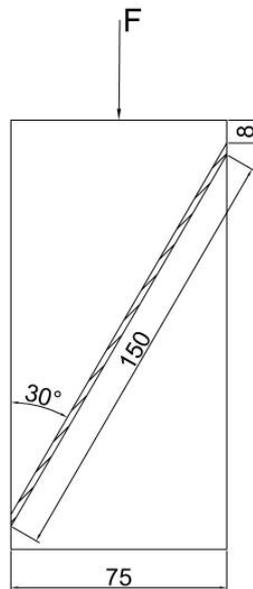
混凝土与混凝土压缩剪切强度试件尺寸（单位：mm）
